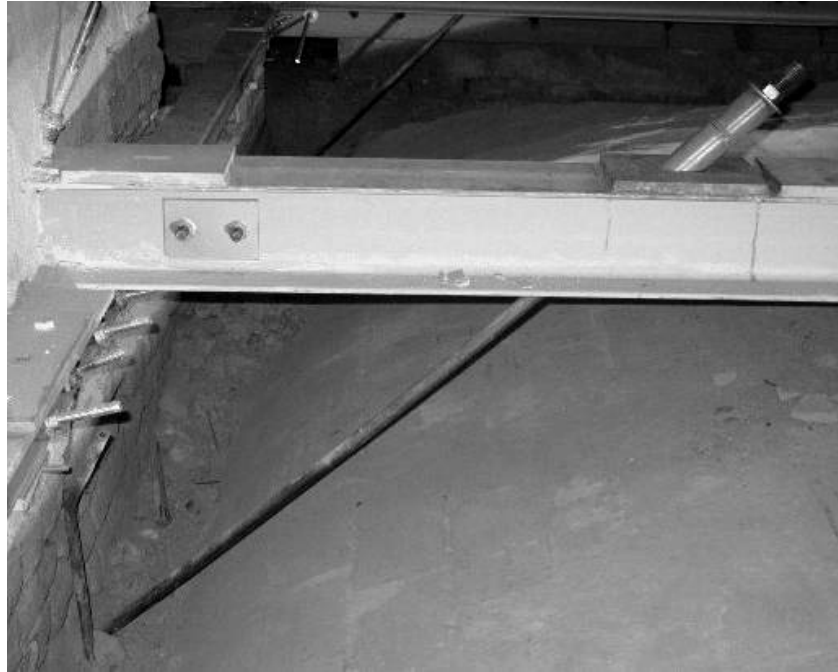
Consolidamento con sistema a “graffette”: schema statico ed esempio di un nodo tirante-trave
